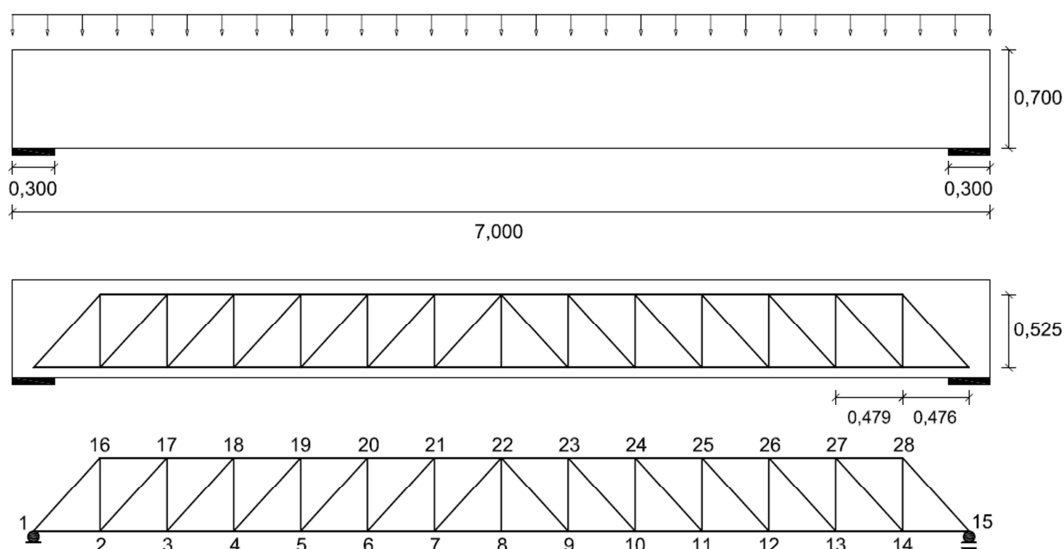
Elemento estrutural e treliça representativa (Viga 3) – Secção 0,70x0,30.
